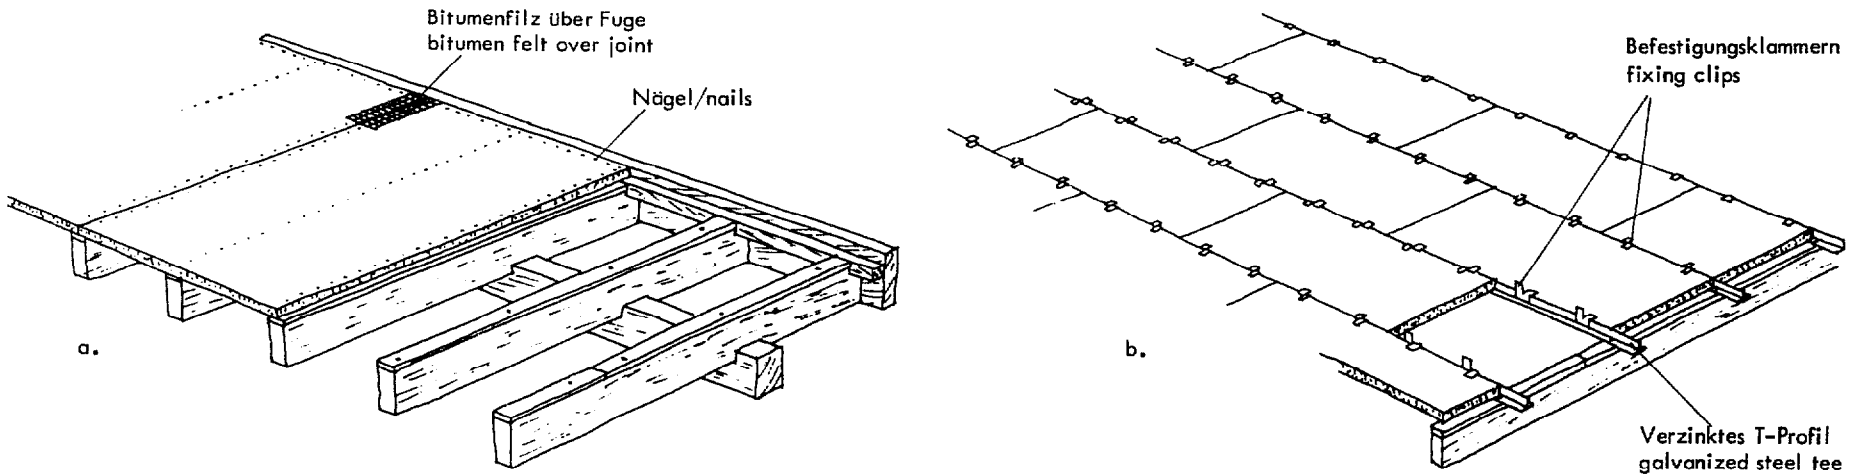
Befestigungsdetails der Dichtungsbahnen.
